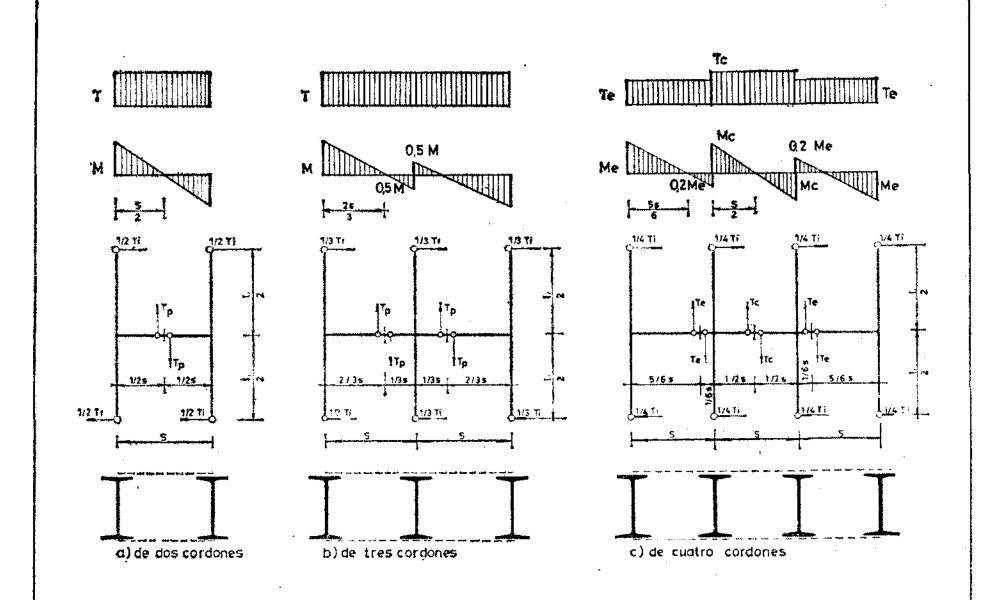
Esfuerzo cortante y momento flector en las presillas de las piezas compuestas
